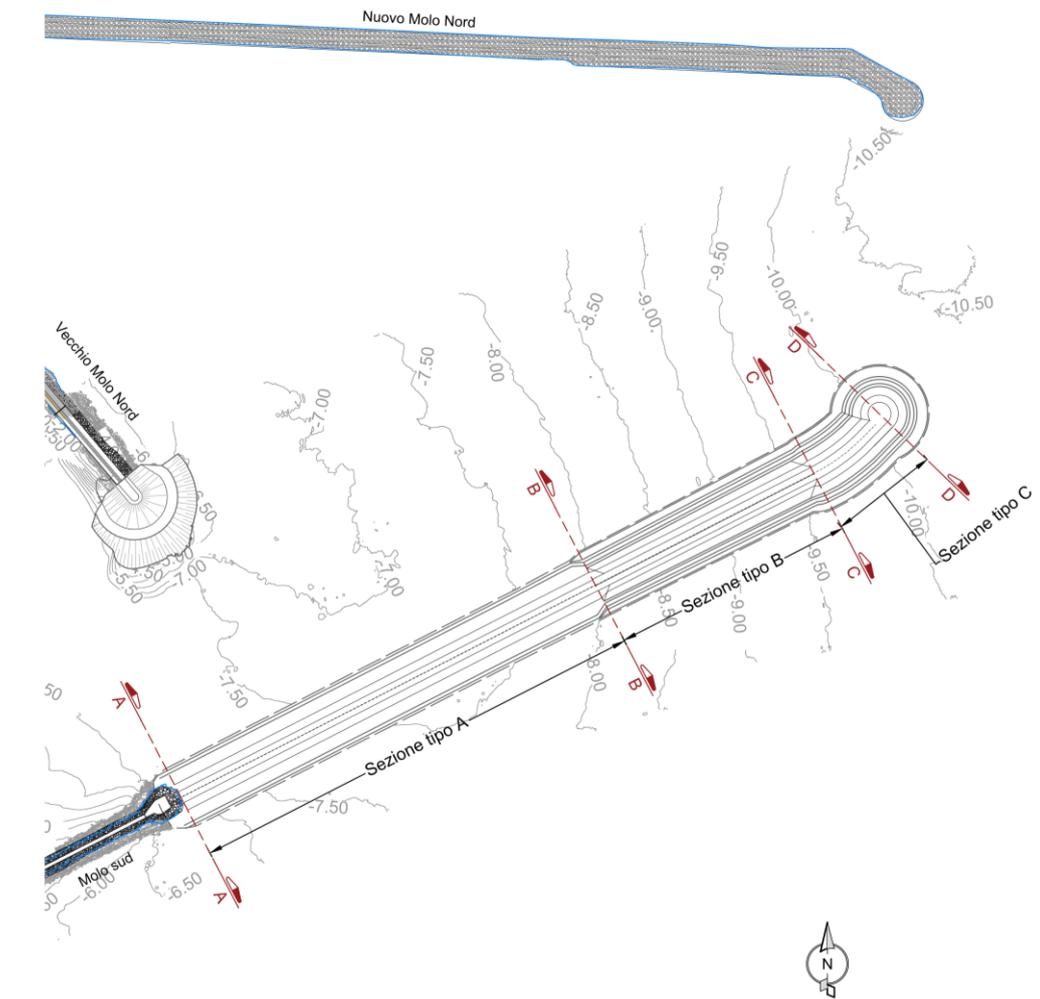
Planimetria delle sezioni per il prolungamento della Diga Foranea Sud
